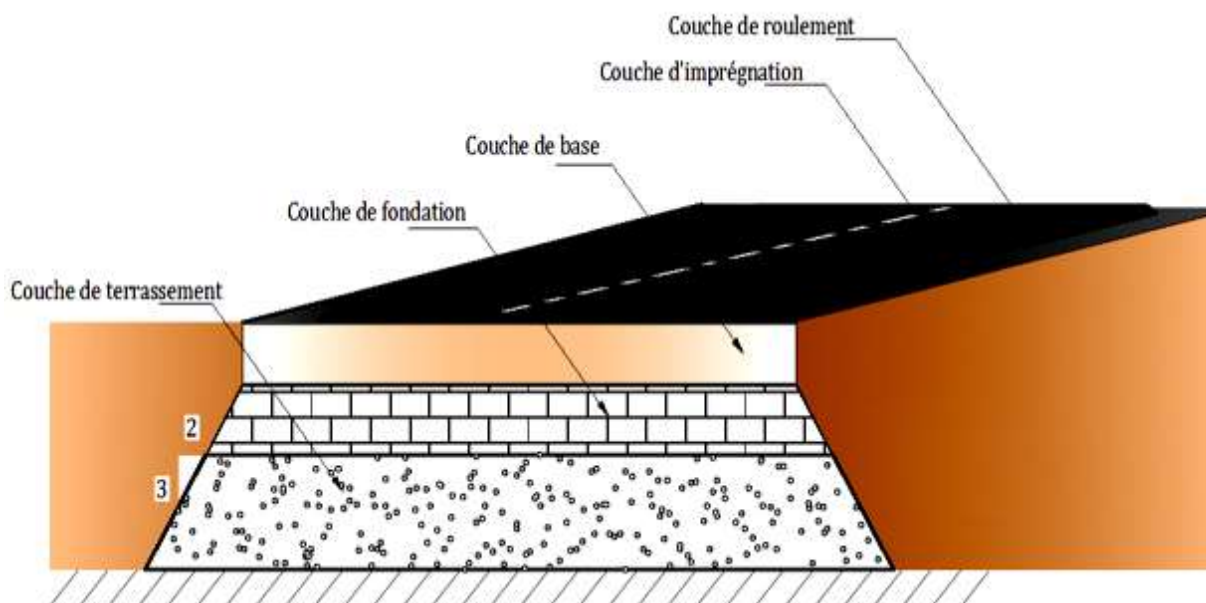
Coupe transversale type d'une chaussée saharienne[16] .
